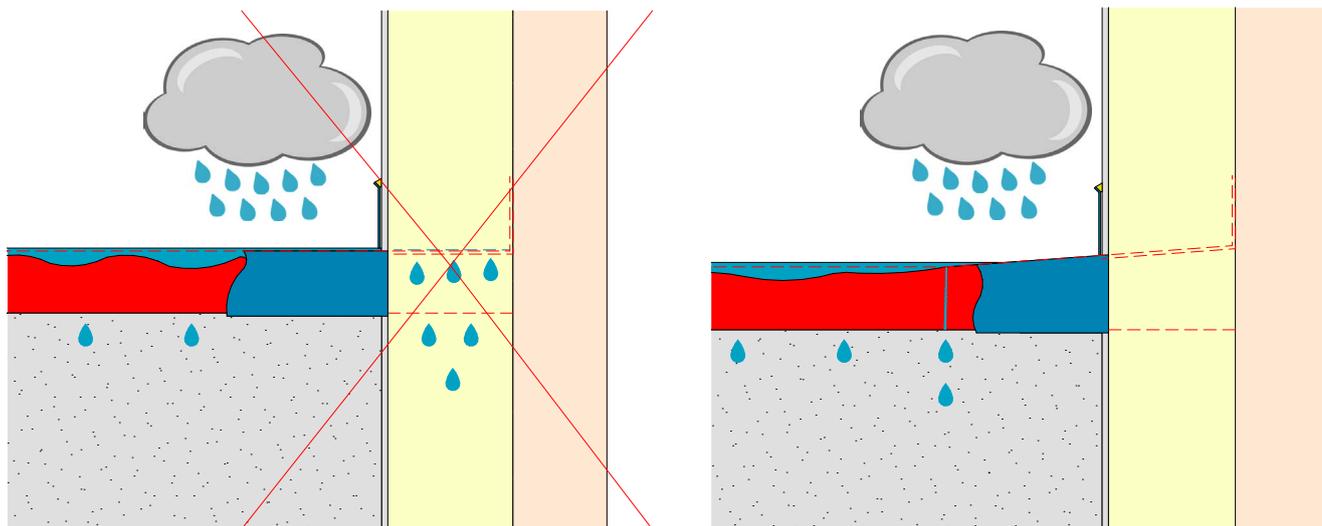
Sezione della terminazione del bordo del tetto con raccordo al muro più alto di almeno 25 mm
